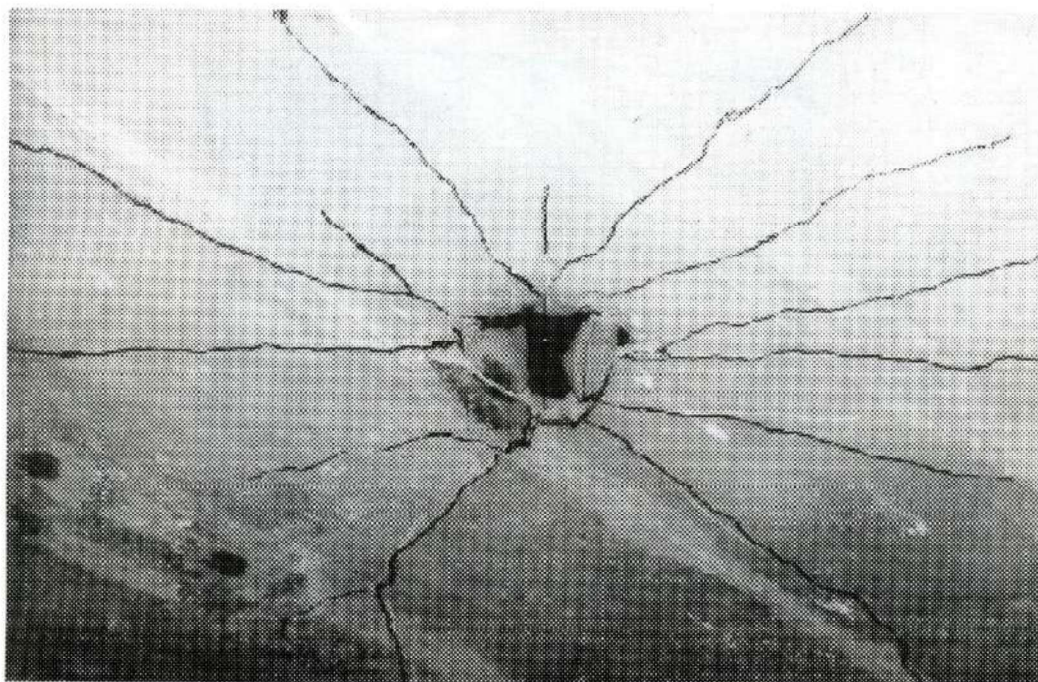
Fissuration - face supérieure, Modèle M45
